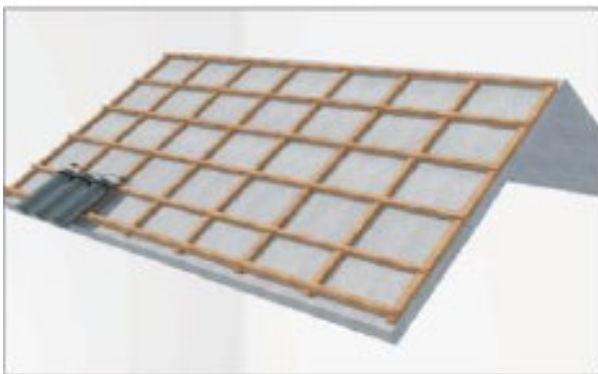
Установка солнечной черепицы на бетонной крыше
